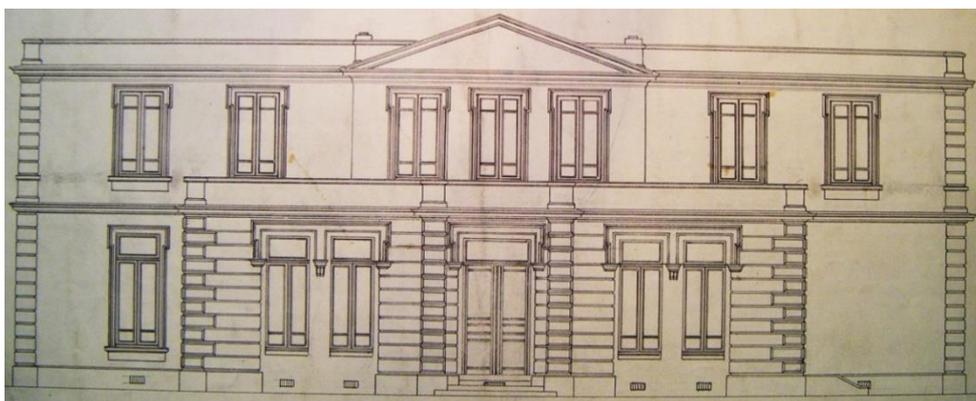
Plano de la Fachada de la Legación Británica elaborado por Thomson, 1890 (Works 40/118 Front elevation)
